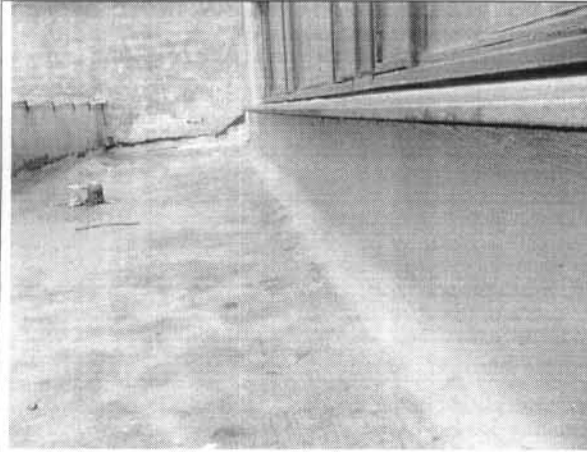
Vista de la placa de cubierta contigua al mezanine.
